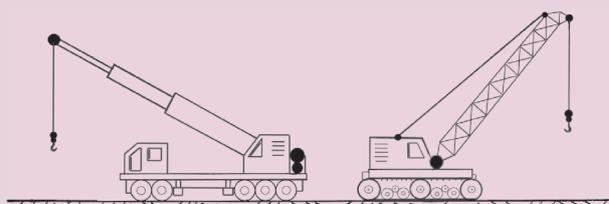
Grues terrestres : à gauche, sur pneus avec flèche télescopique ; à droite, sur chenilles avec flèche en treillis
